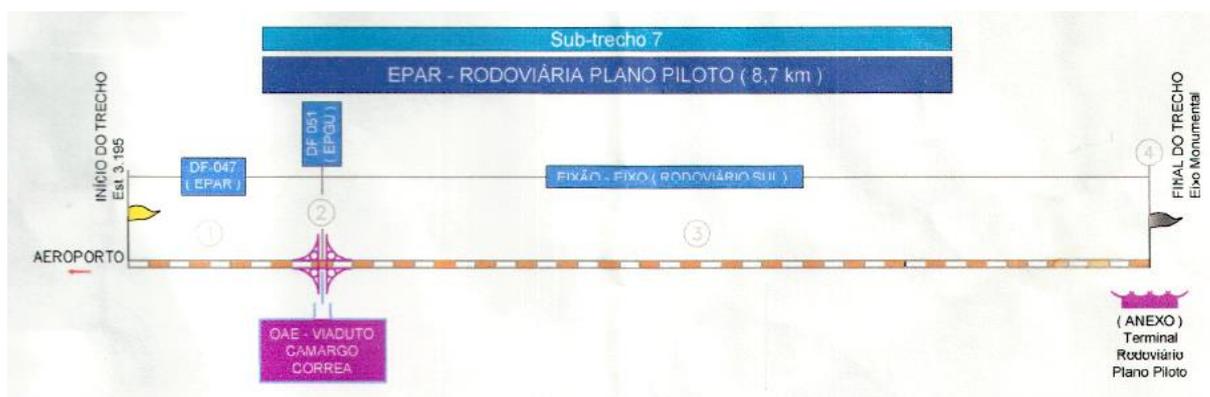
Sub-trecho7: EPAR – Rodoviária Plano Piloto.
